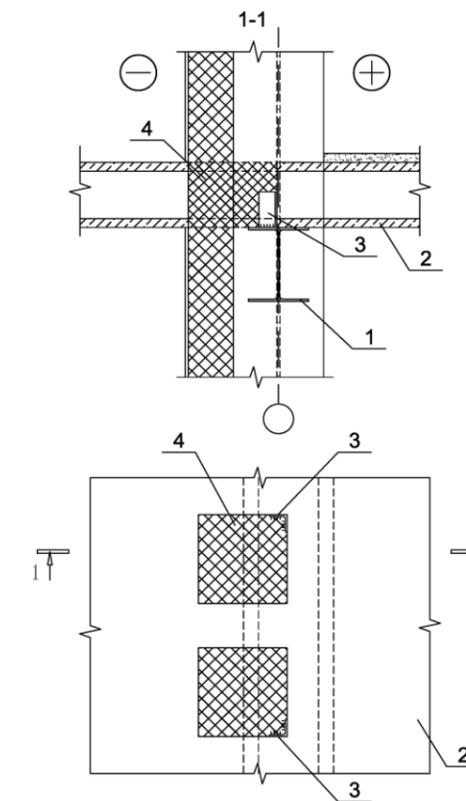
Опираение плит перекрытий с балконной консолью на ригель. 1- ригель, 2-плита перекрытия, 3- упоры из уголка, привариваются после установки плиты, 4- утеплитель минераловатные плиты
